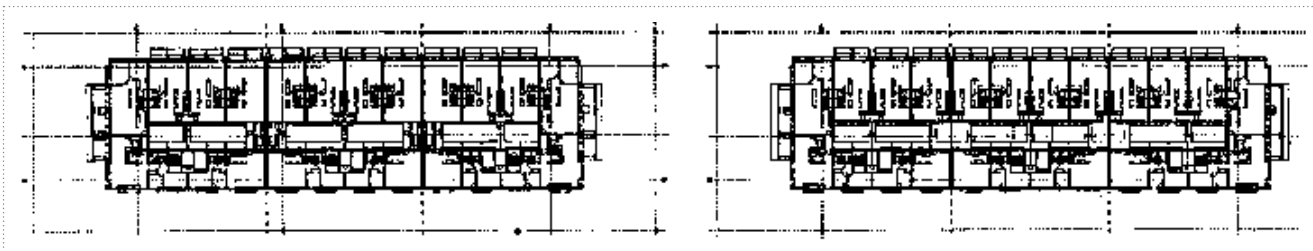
Planta 2º e 3º pavimento do Galpão 8, respectivamente.
